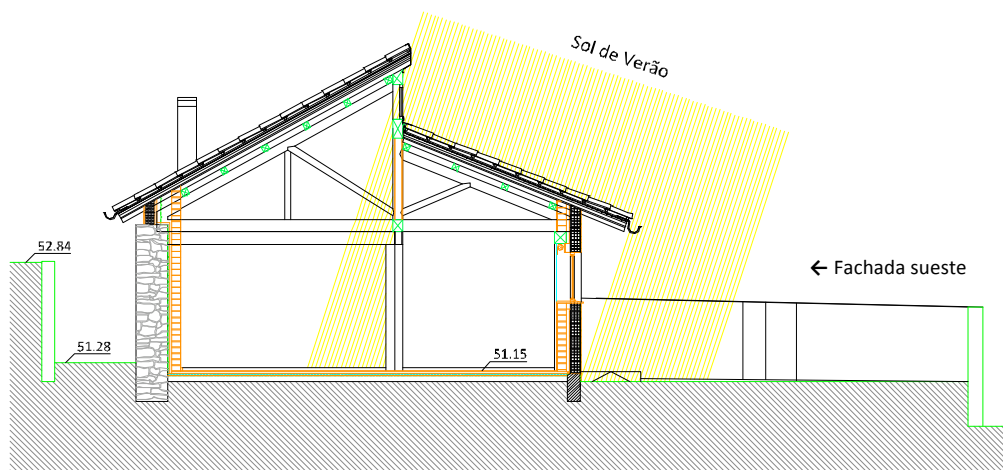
Corte Transversal FF' - Funcionamento das aberturas na cobertura e do beiral na fachada sueste durante o sol de verão
